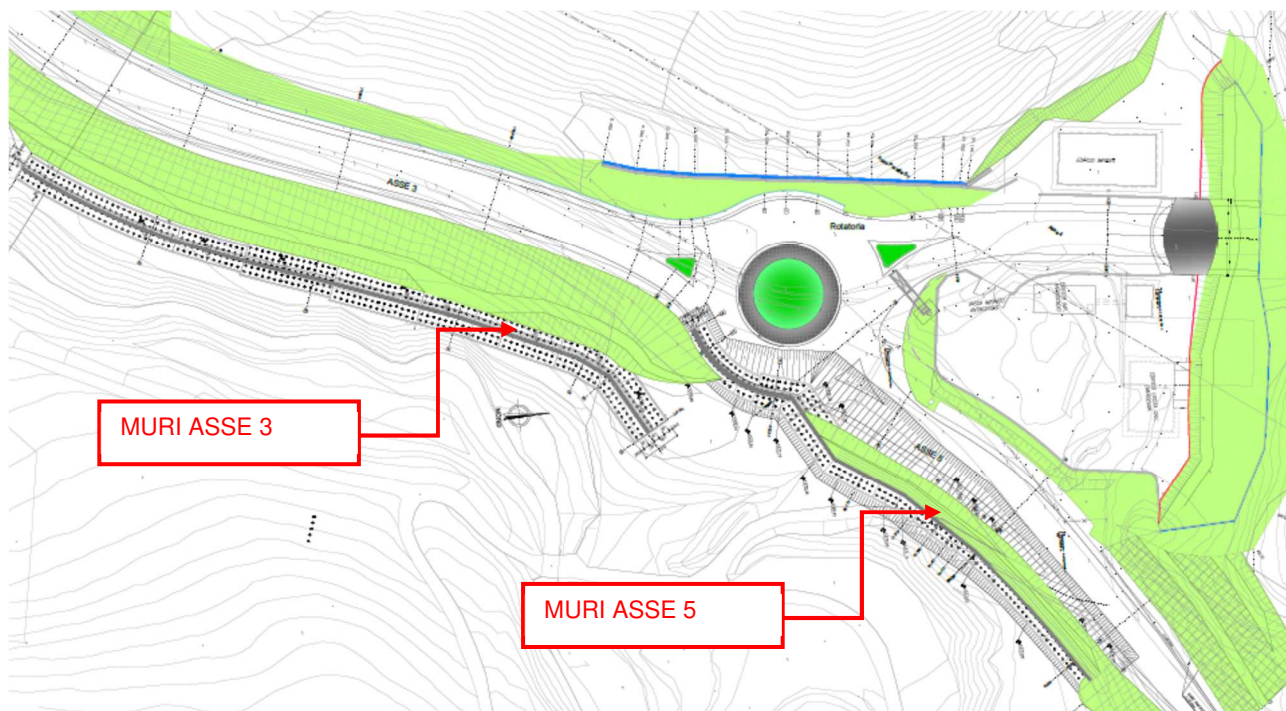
Stralcio planimetrico muri Asse 3 e Asse 5.
